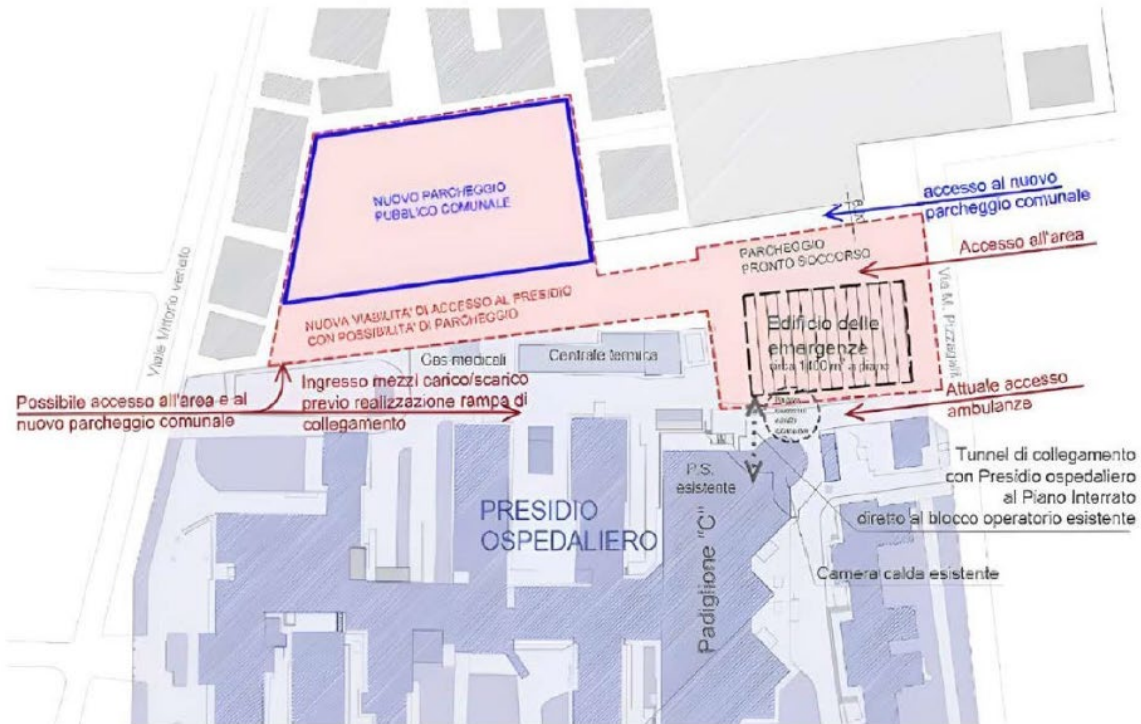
Planimetria di progetto con il dettaglio dei vari interventi
